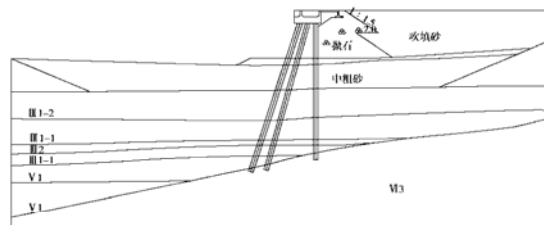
14-14 剖面双排斜顶桩板桩结构方案简化断面示意图
